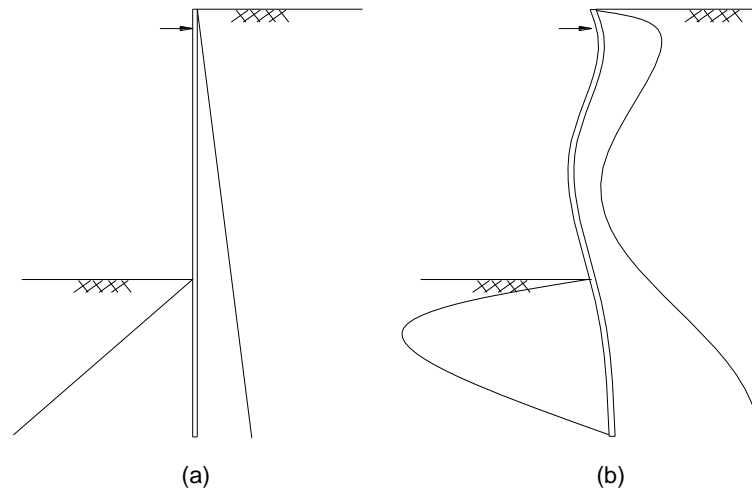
Influência da flexibilidade da parede na distribuição das pressões: a) parede rígida; b) parede flexível (Padfield e Mair, 1984 citado por Puller, 2001)
